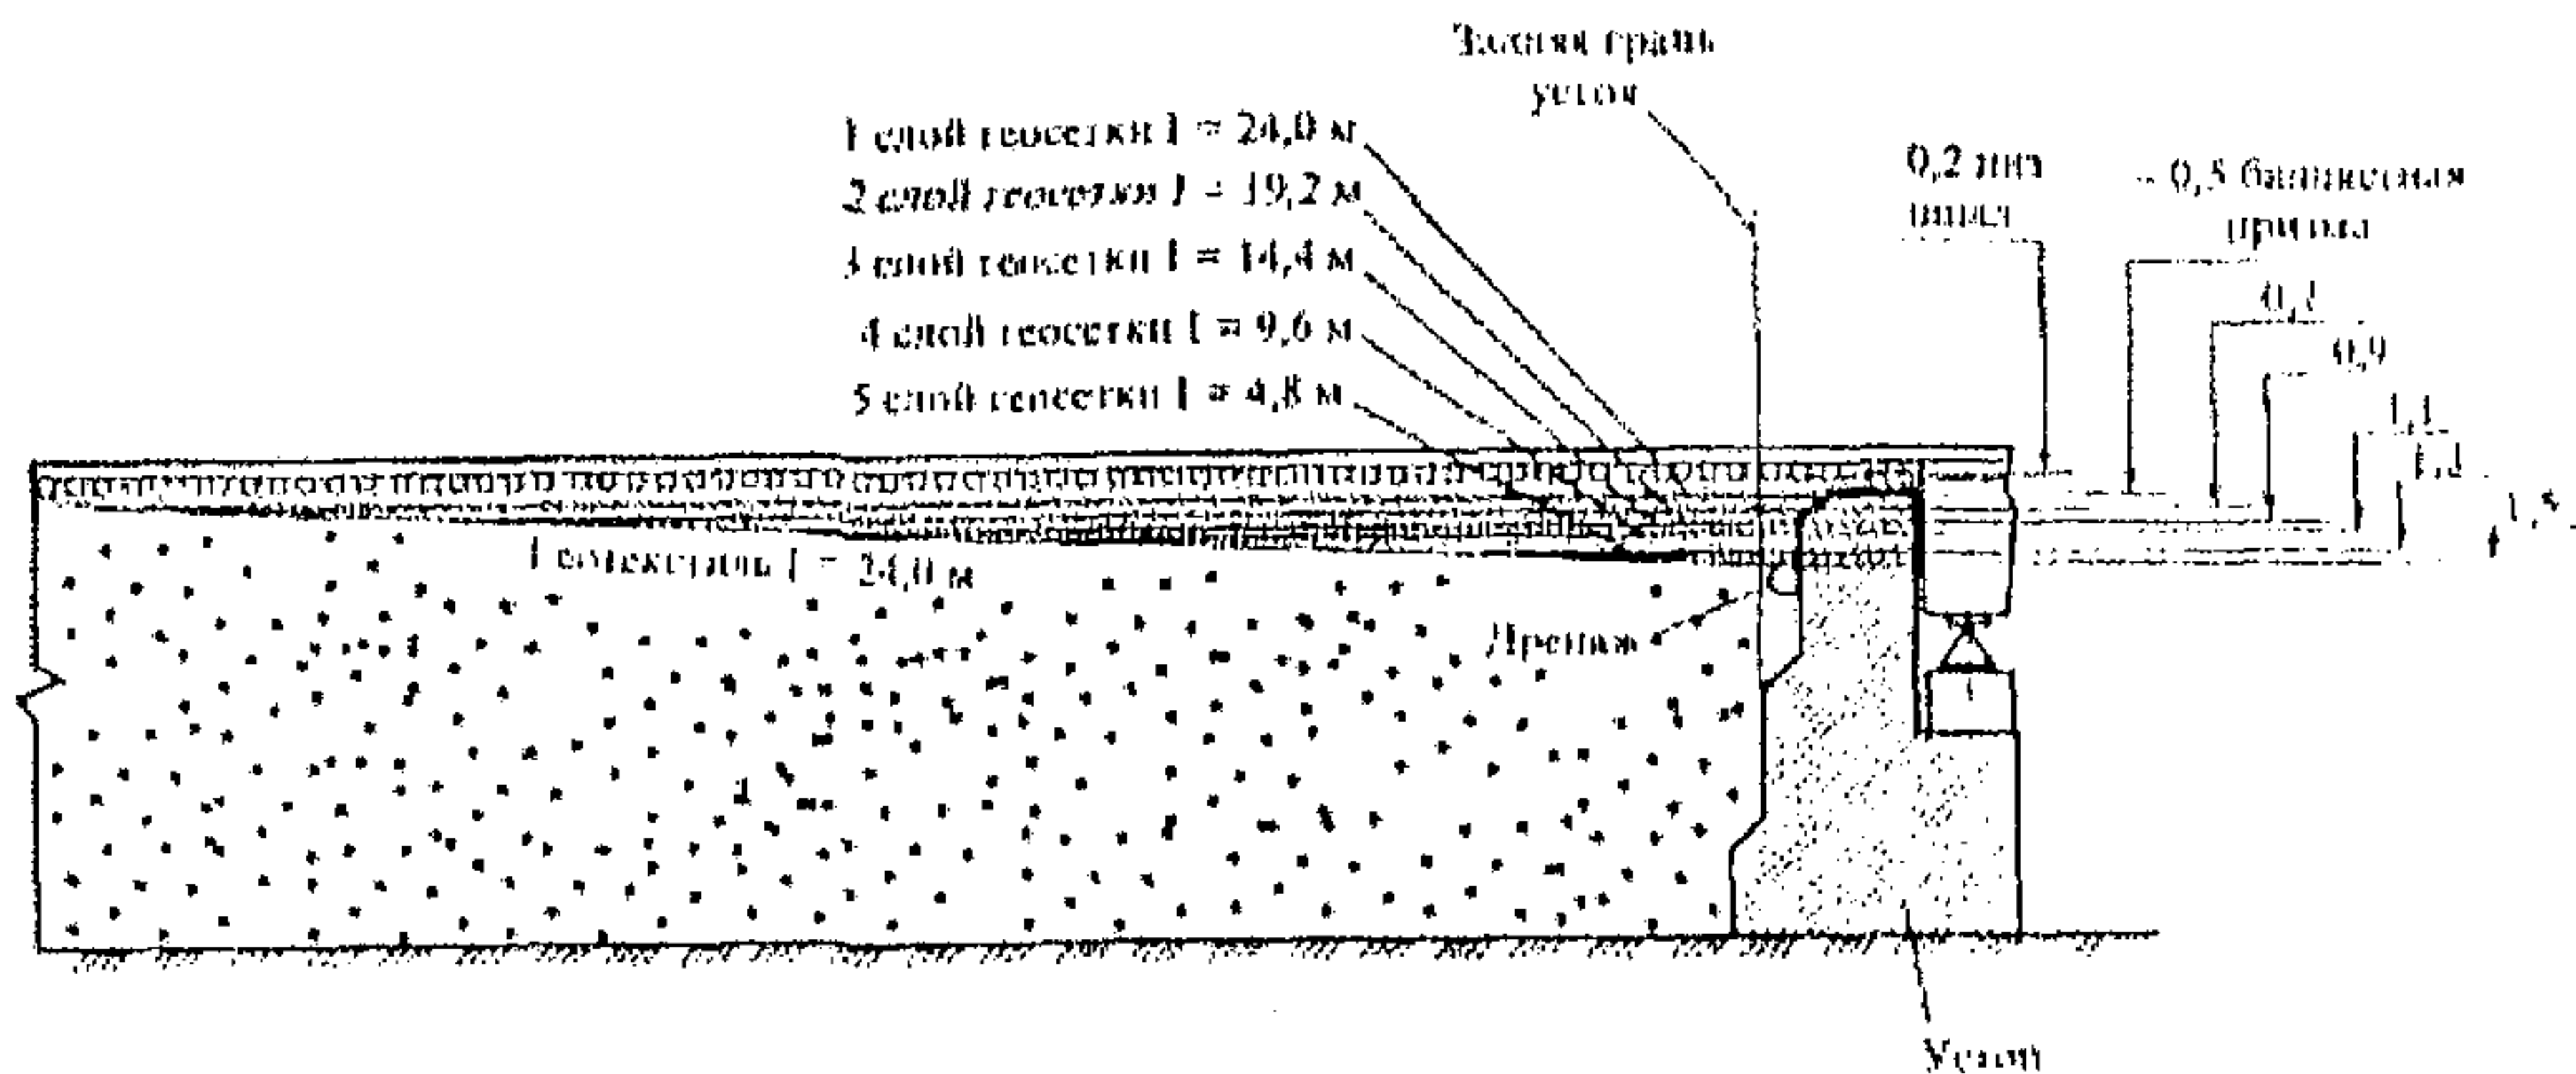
Переходный путь с заменой грунта верхней части насыпи на щебень, укладываемый между слоями геосеток.
